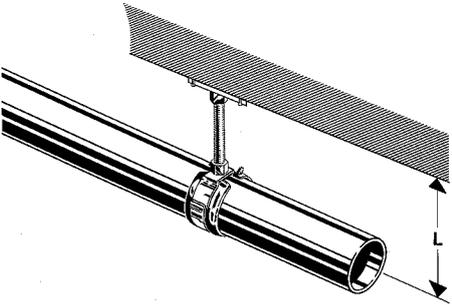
Fixpunkt mit Geberit Elektroschweißband für Fixpunkt Art.-Nr. 36X.776.16.1
